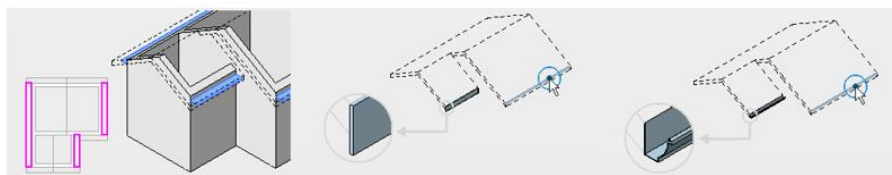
De izquierda a derecha: cubierta a cielo raso, cubierta con imposta, cubierta con canalón.
